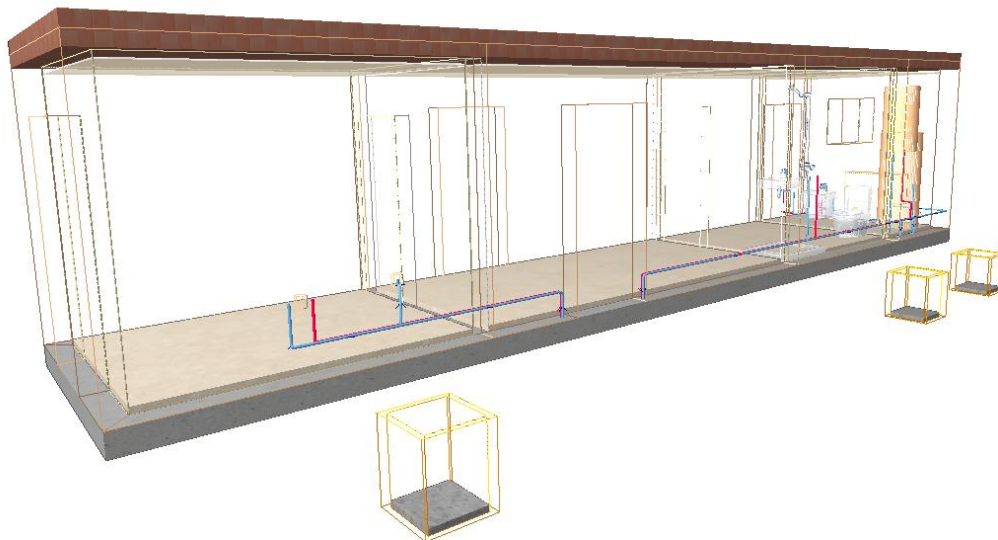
Vista 3D do traçado da rede de abastecimento de água (*cype*)
